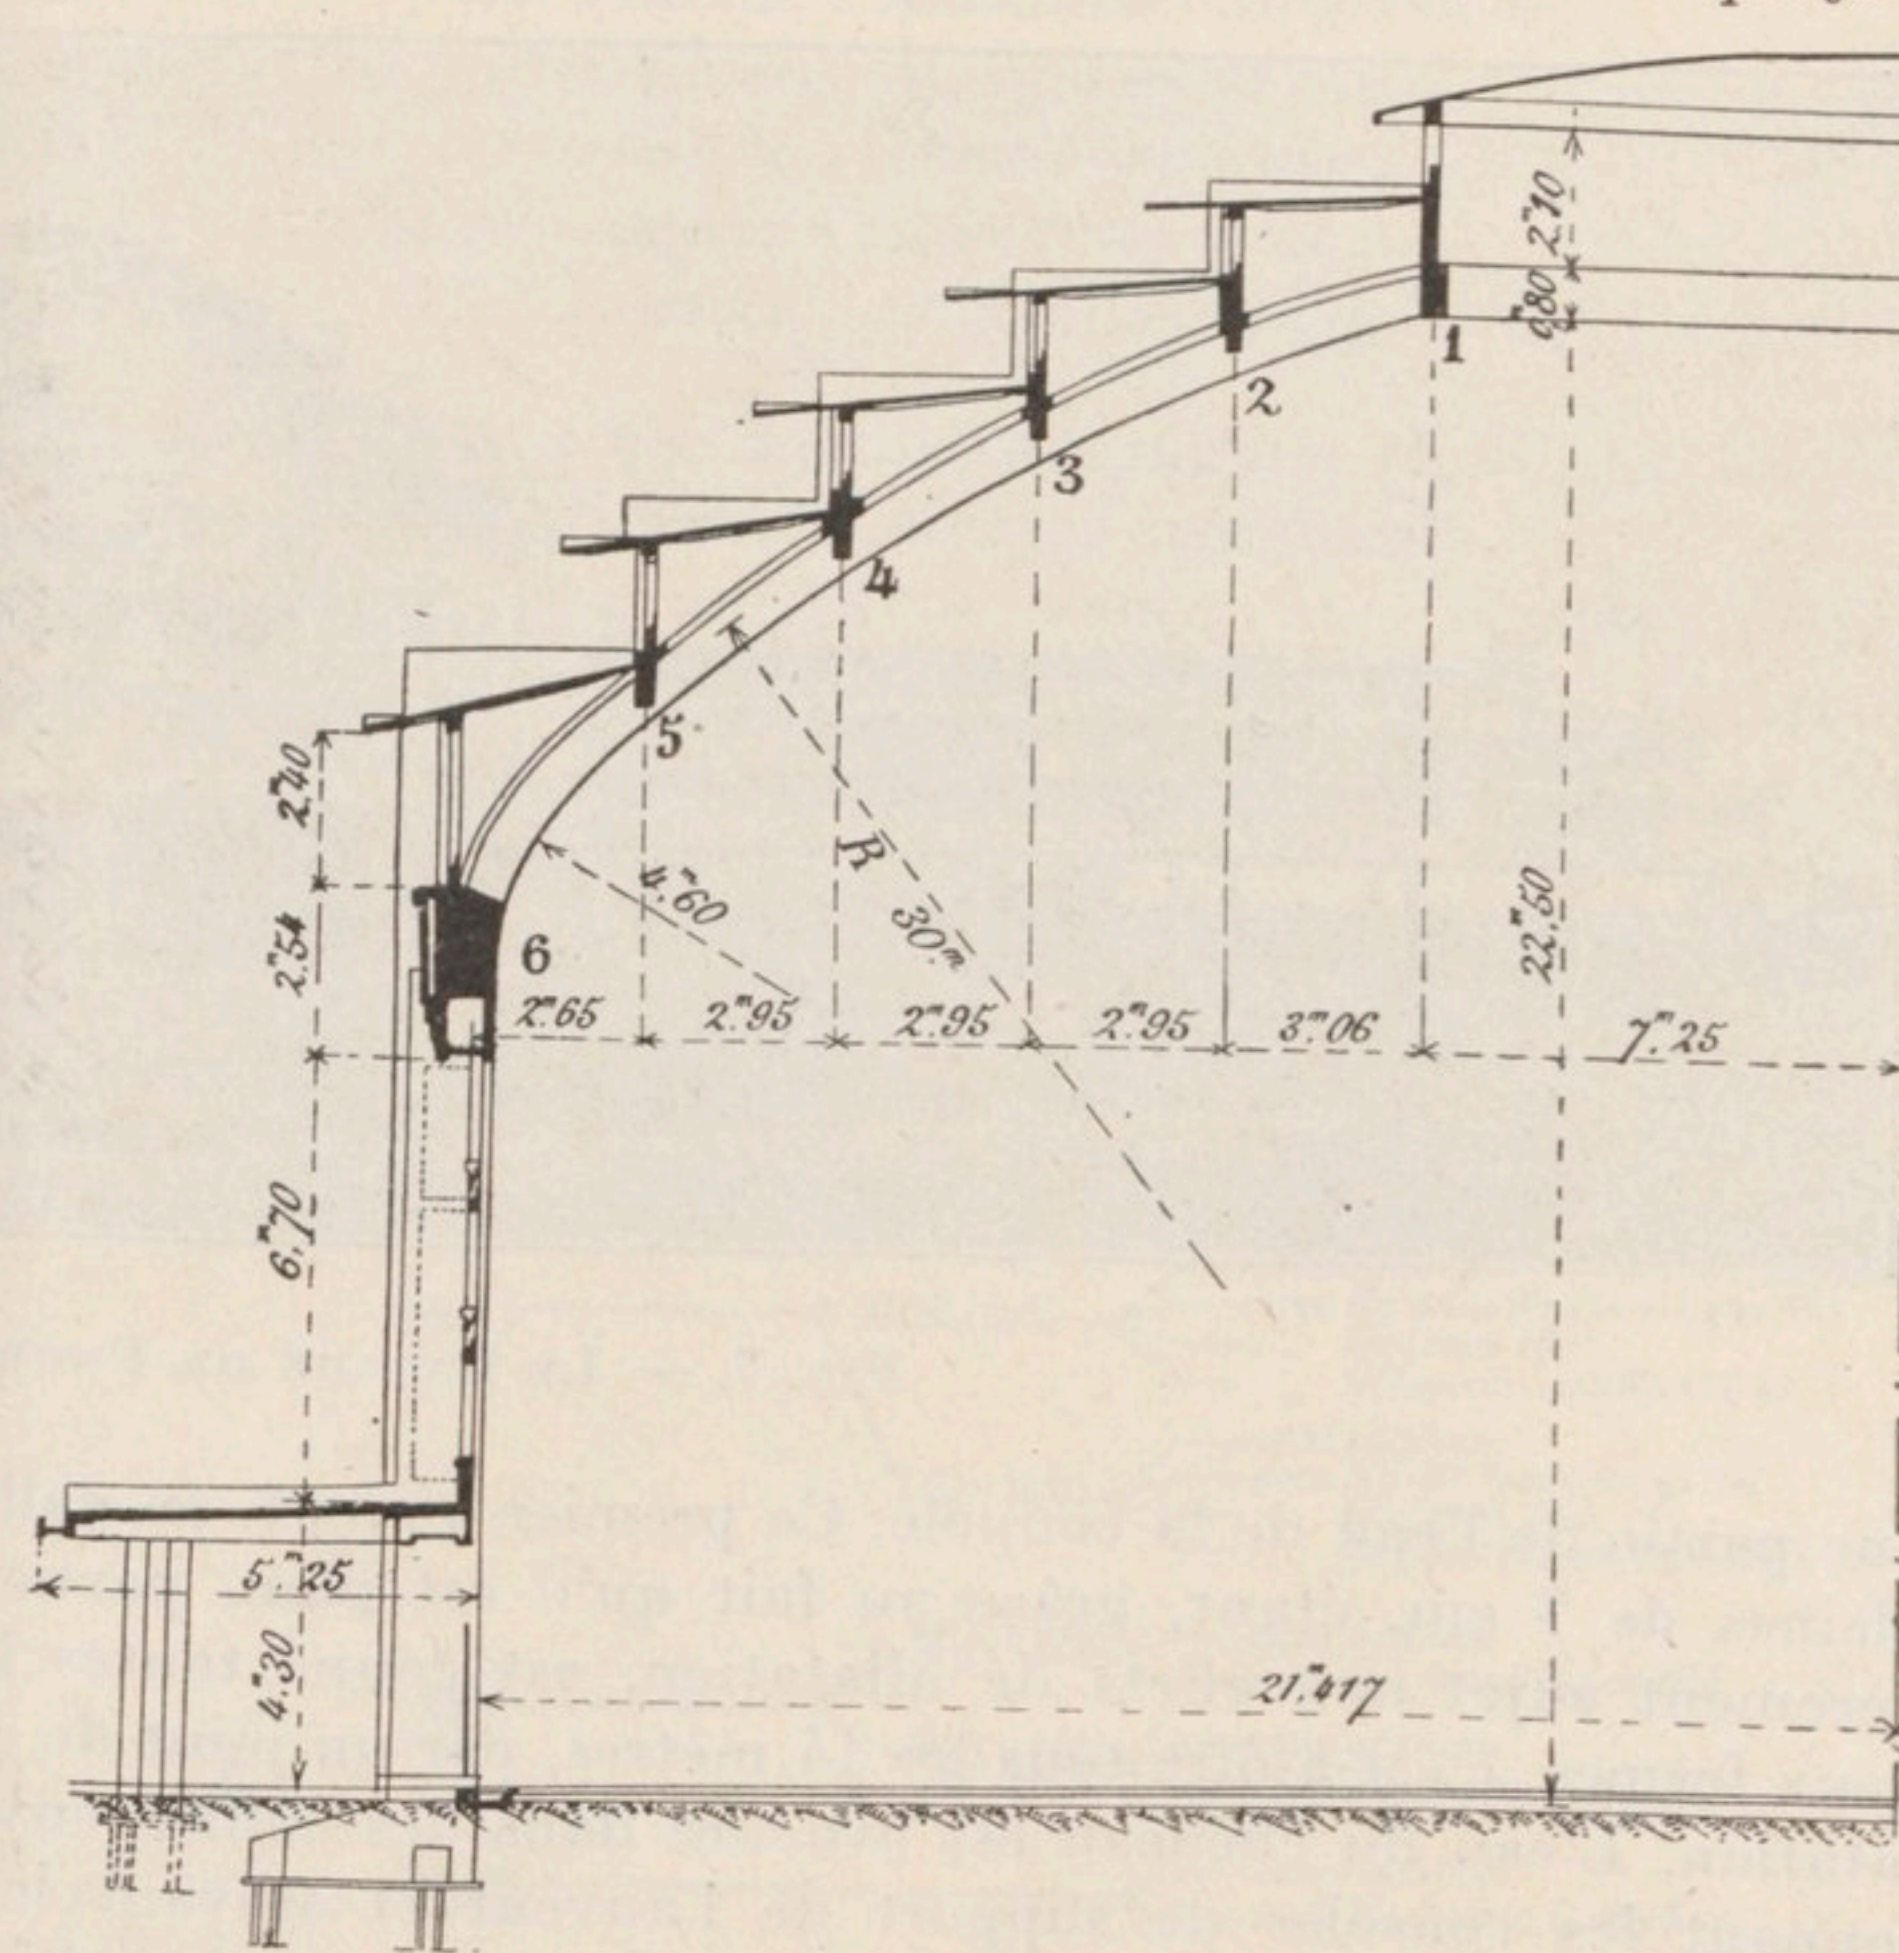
Demi-coupe du bâtiment par la coupole.
